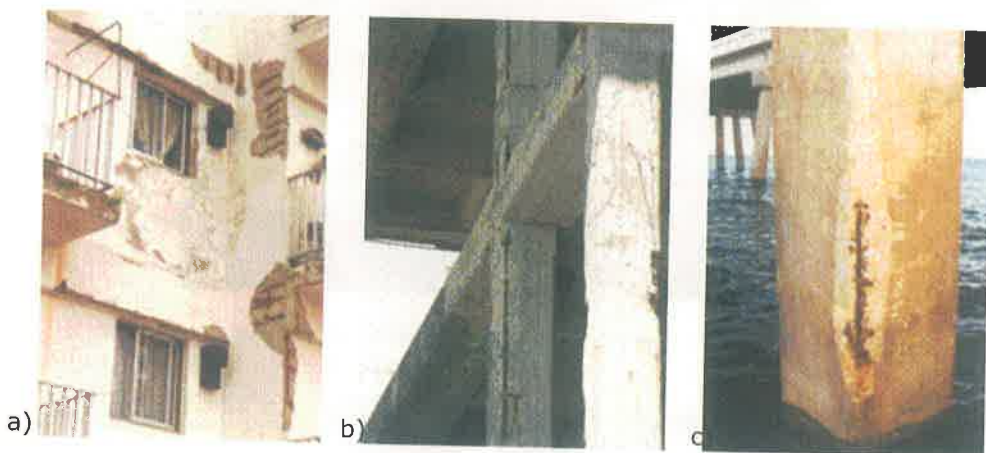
Danos em estruturas de concreto armado causados por corrosão. a) Corrosão por cloretos em fachada de edifício, b) Corrosão por carbonatação em estrutura de concreto armado, c) Corrosão por cloretos em pilar protendido
